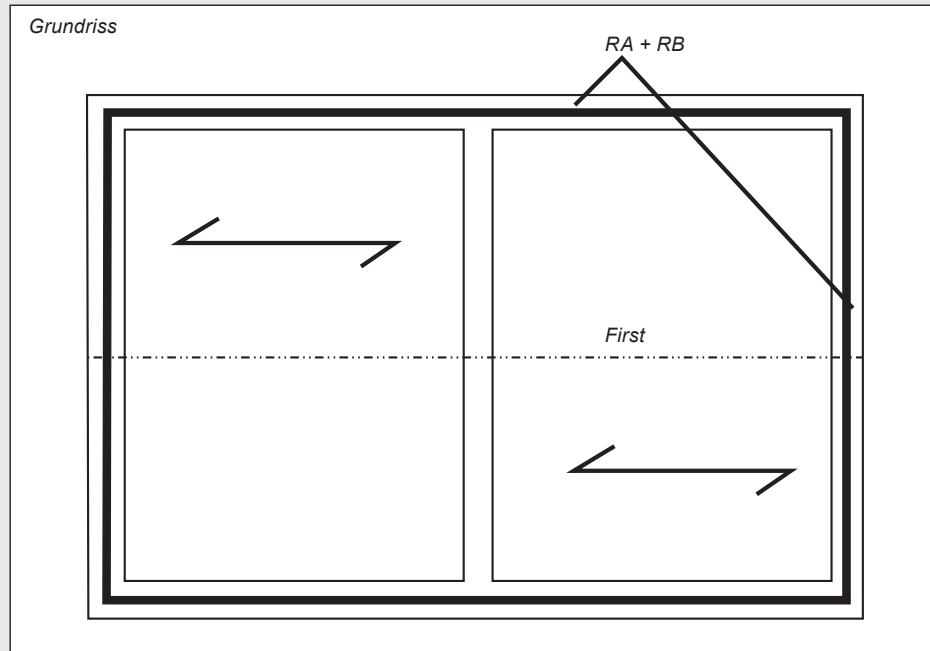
Verknüpfung von Ringanker und Ringbalken, Grundriss
